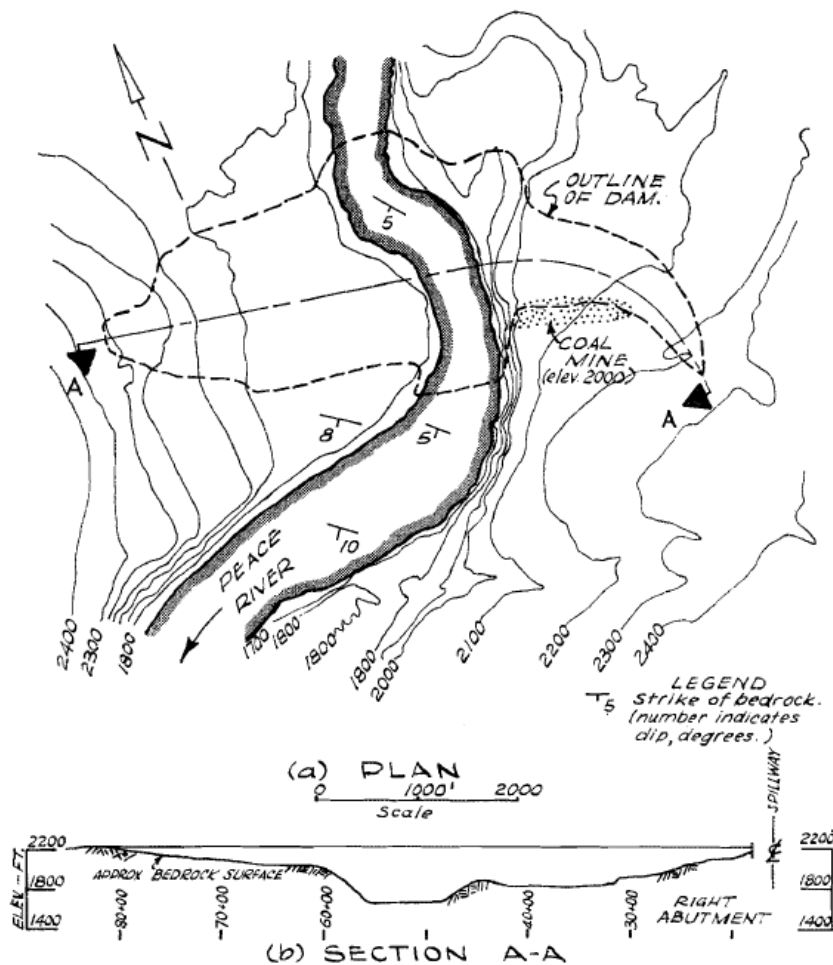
Topografía del sector de la presa y eje central proyectado (Ripley, 1967)
